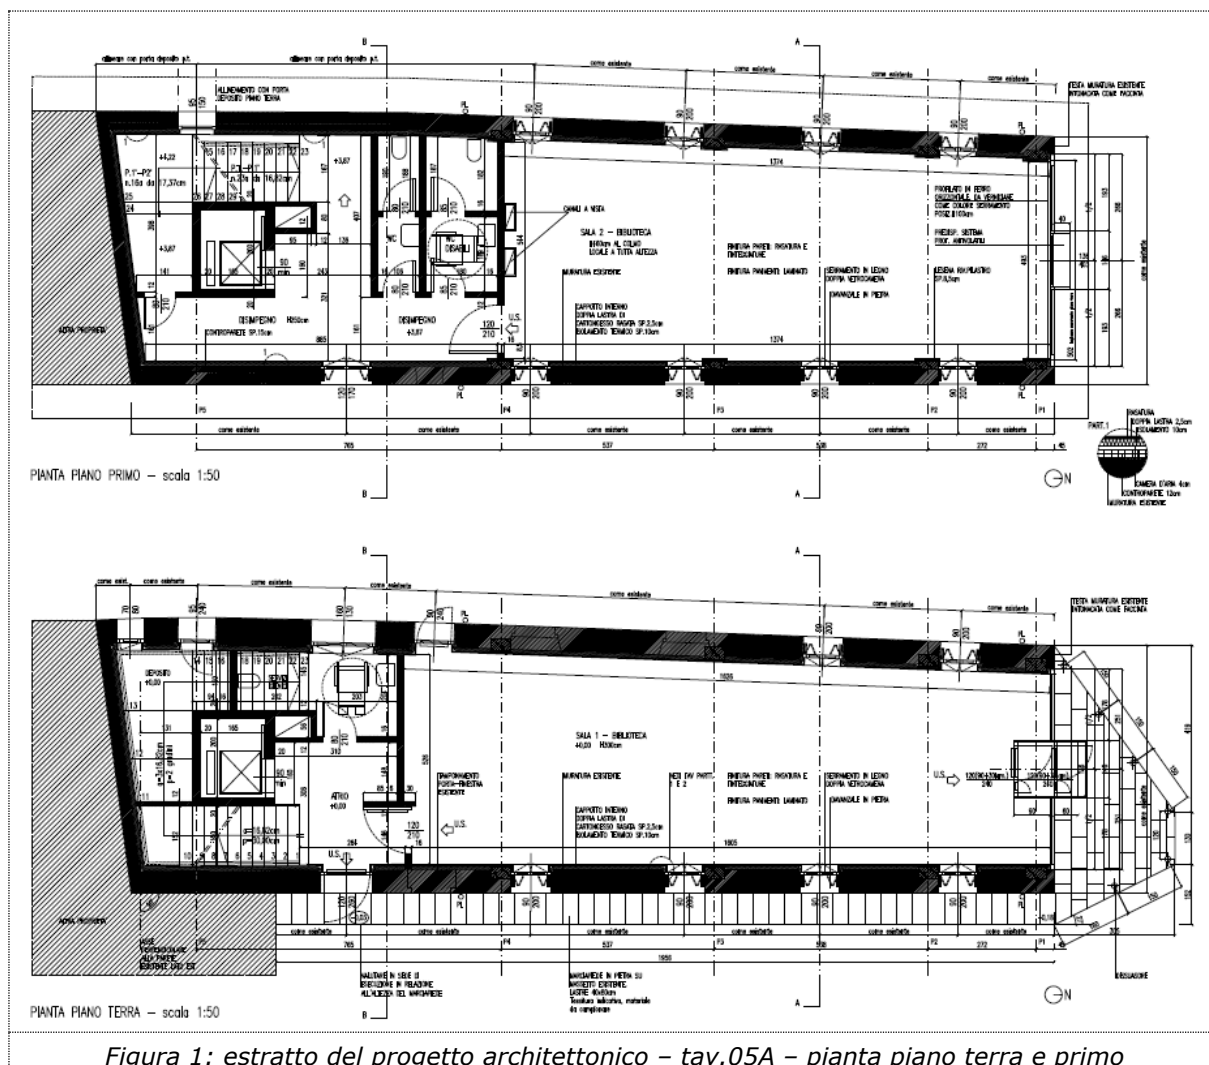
estratto del progetto architettonico – tav.05A – pianta piano terra e primo
